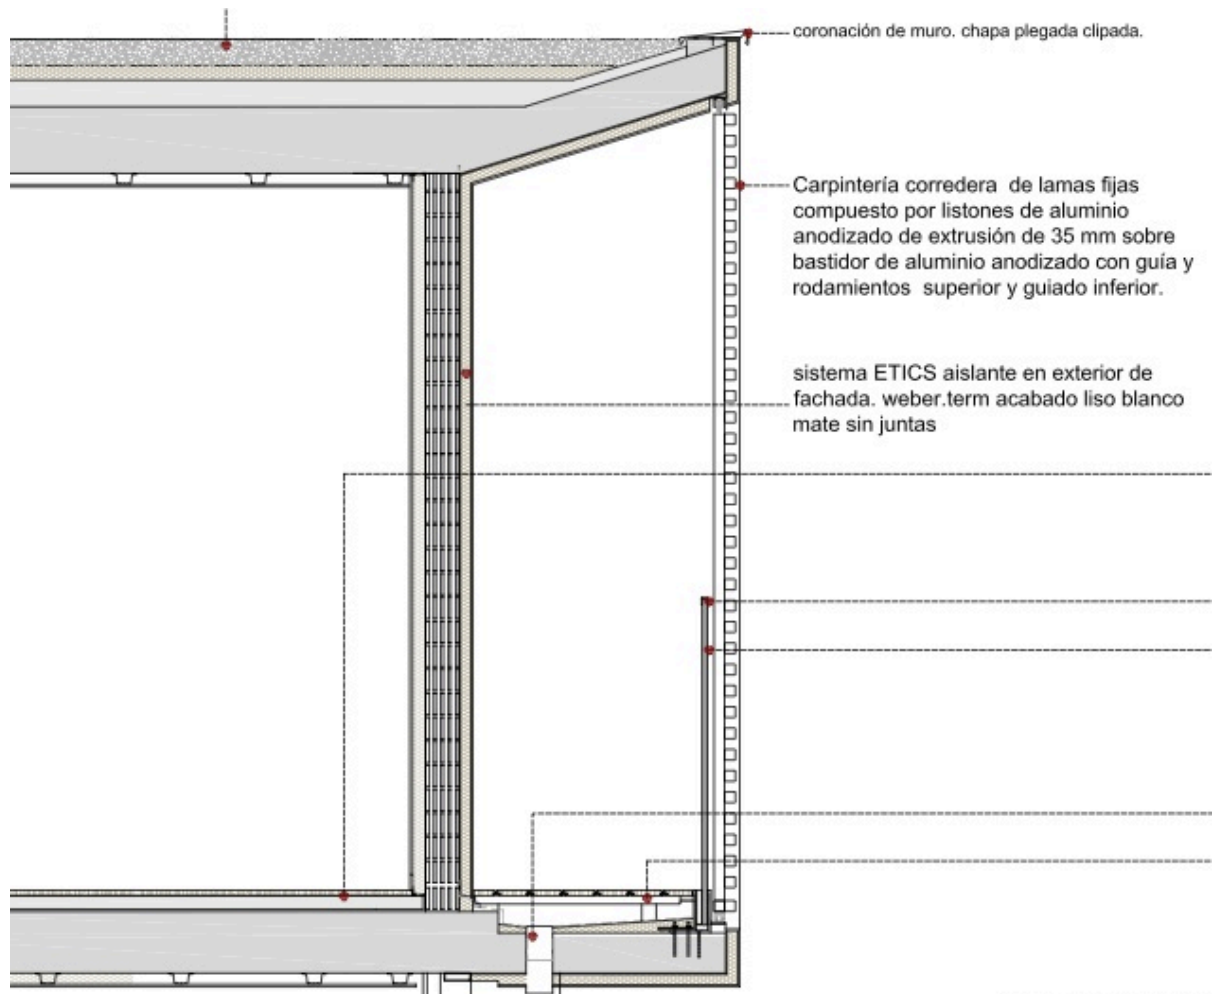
Detalle de la sección de la perfilería con lamas correderas en terraza
